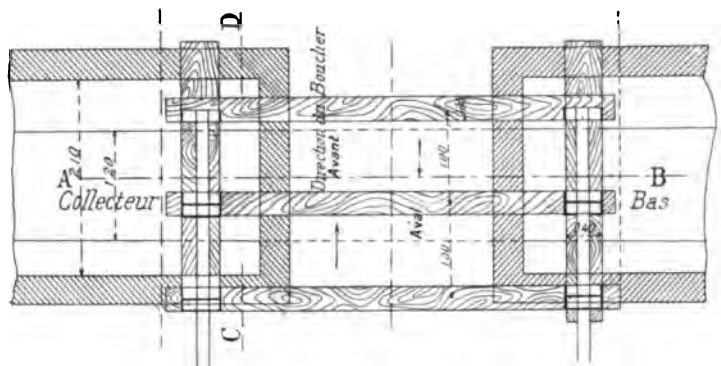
Franchissement du collecteur de l'Université. Plan du plancher.
